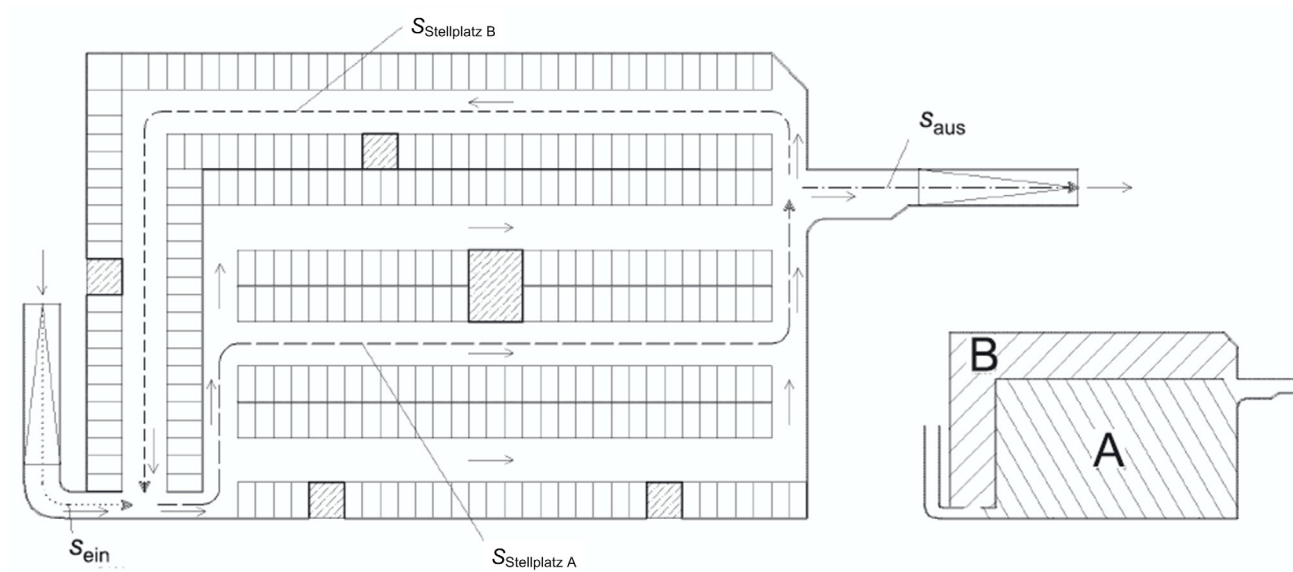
Beispiel – Garagengrundriss einer Wohnhausgarage
